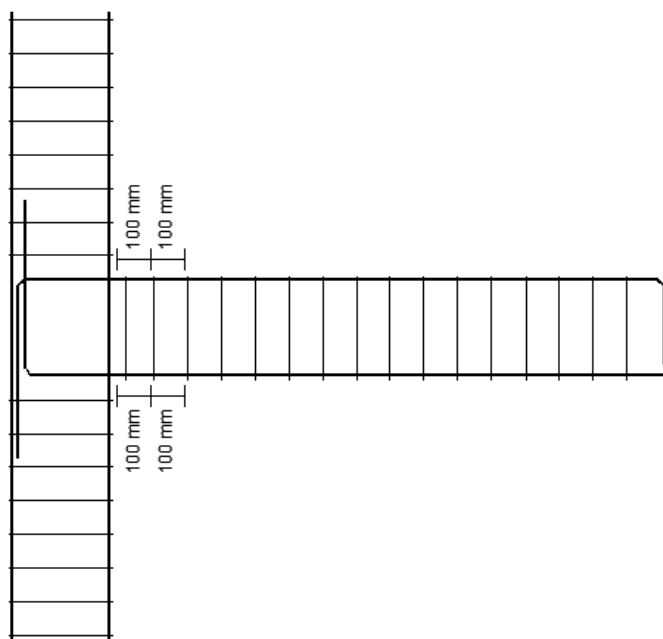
Corte longitudinal da aplicação dos extensómetros
